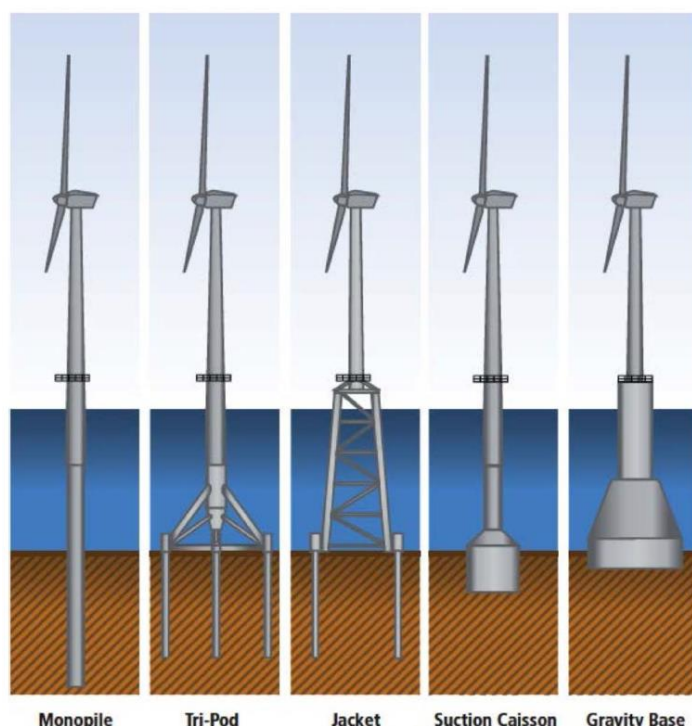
支持構造形式の代表例 (Navigant, 2013)
